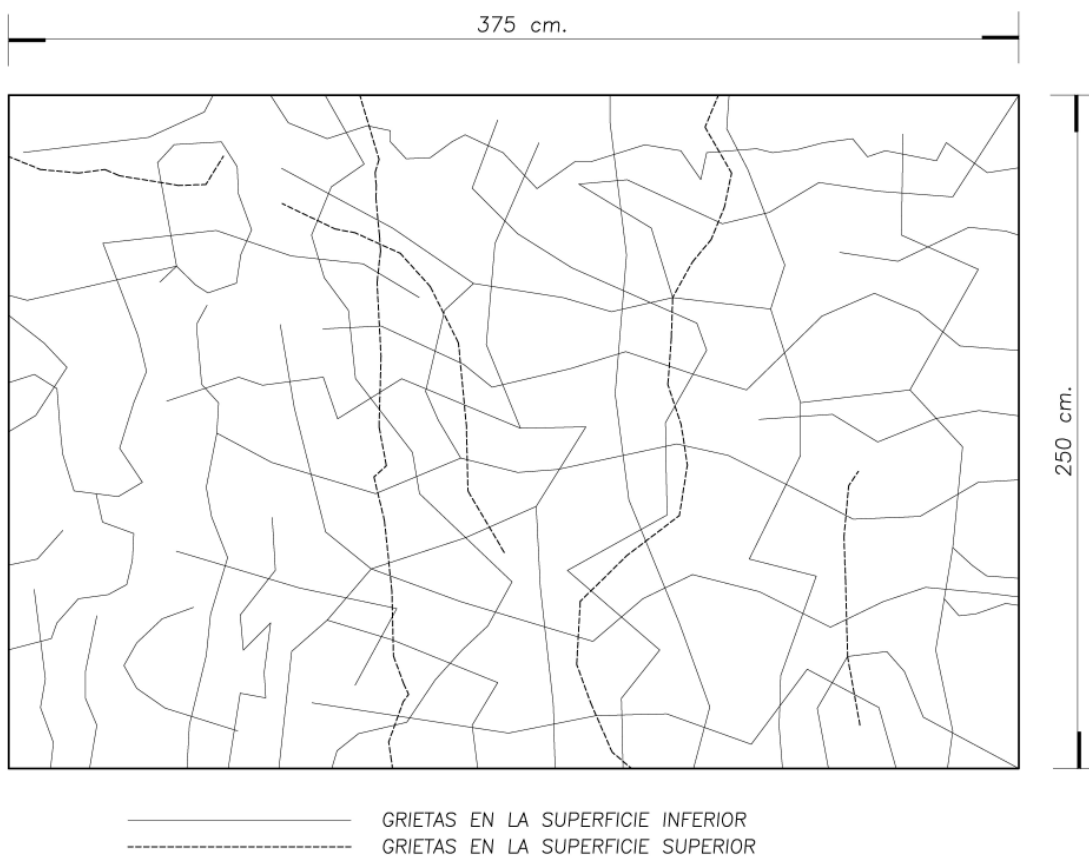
Grietas en la superficie de una losa de concreto reforzado.
